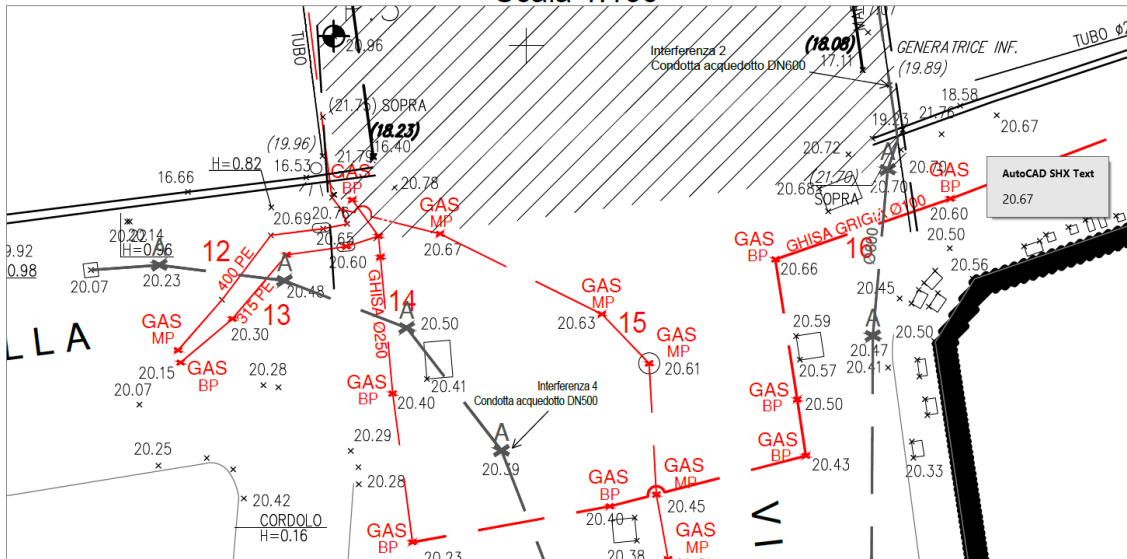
Planimetria di dettaglio dell'area a valle della spalla sud del ponte di via Canepari, con l'evidenza delle condotte del gas presenti. Il retino con linee nere in diagonale indica l'ingombro dell'intervento di sostituzione del ponte
